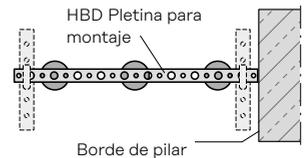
Combinación de 2 elementos HDB – vista en planta
